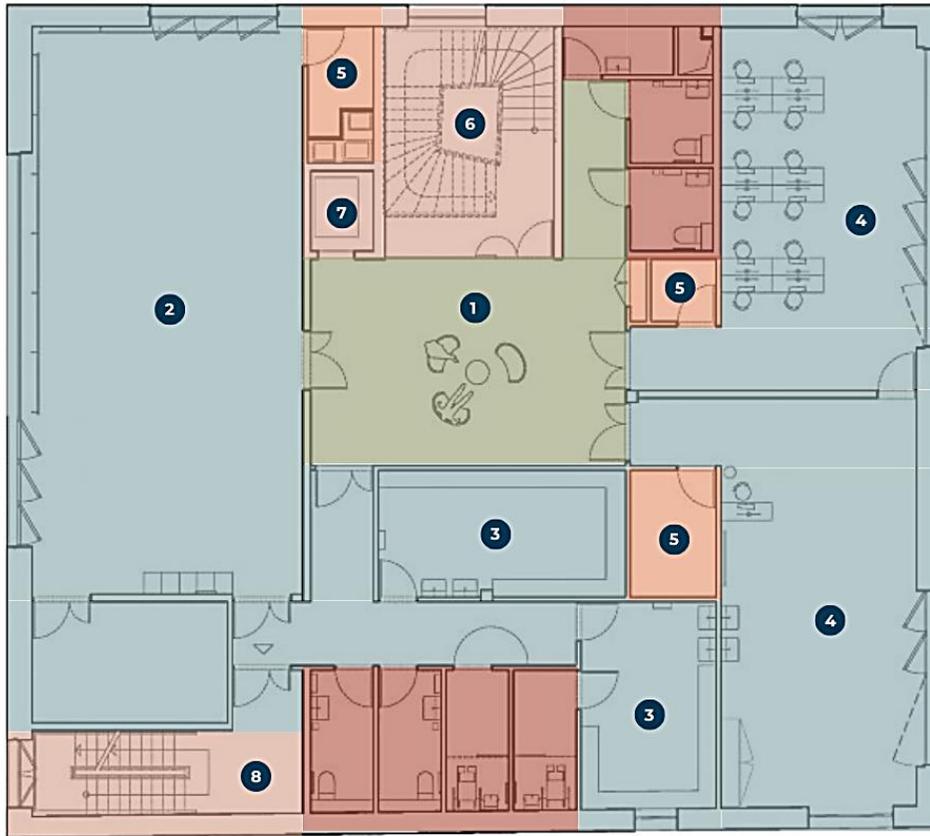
Planta baixa cobertura Centro Cultural Paris Anim
